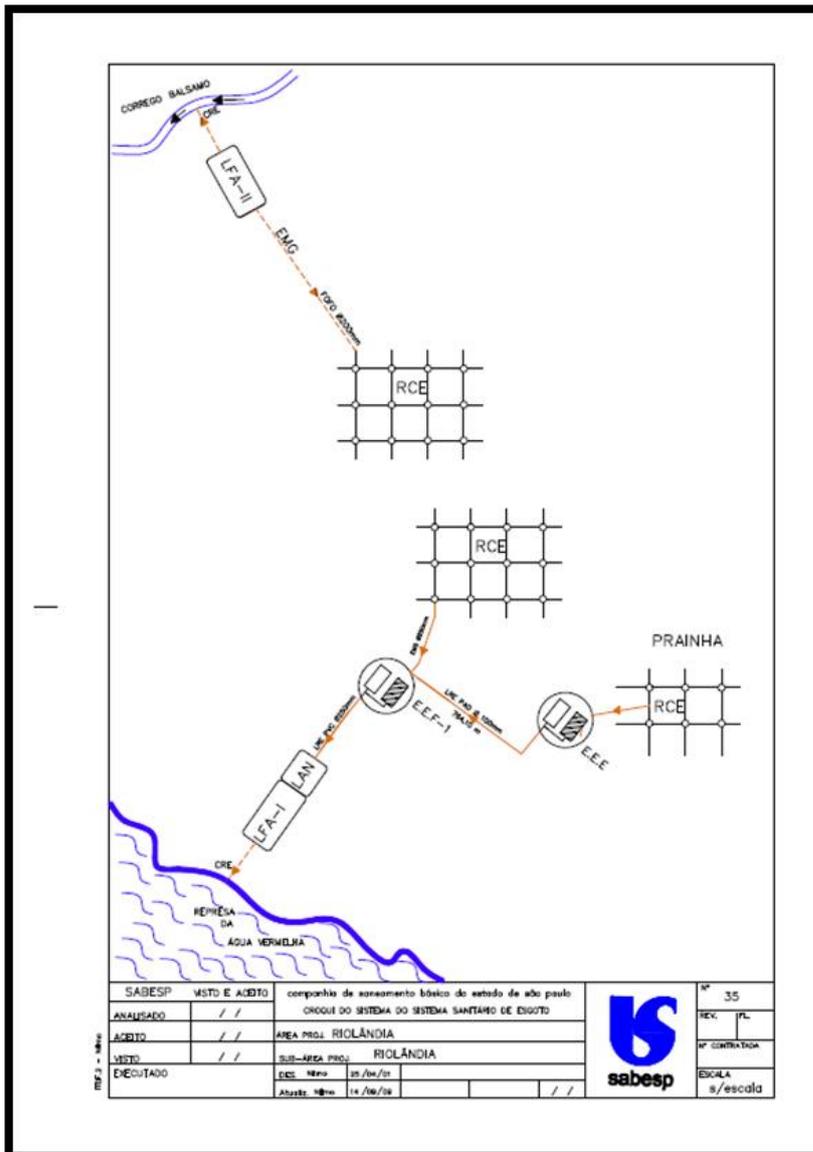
Croqui do Sistema Sanitário de Esgoto
